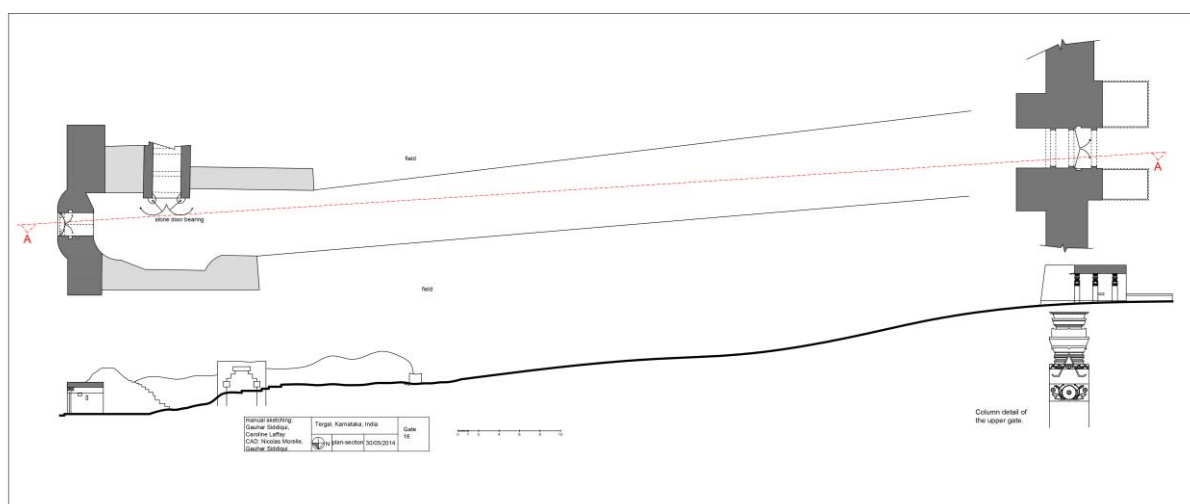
plan et coupe de la porte 16 (a, b, c)
